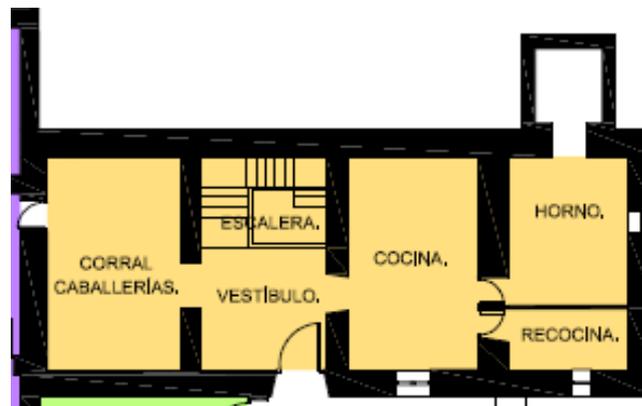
Plano distribución vivienda familiar en Planta Baja.
